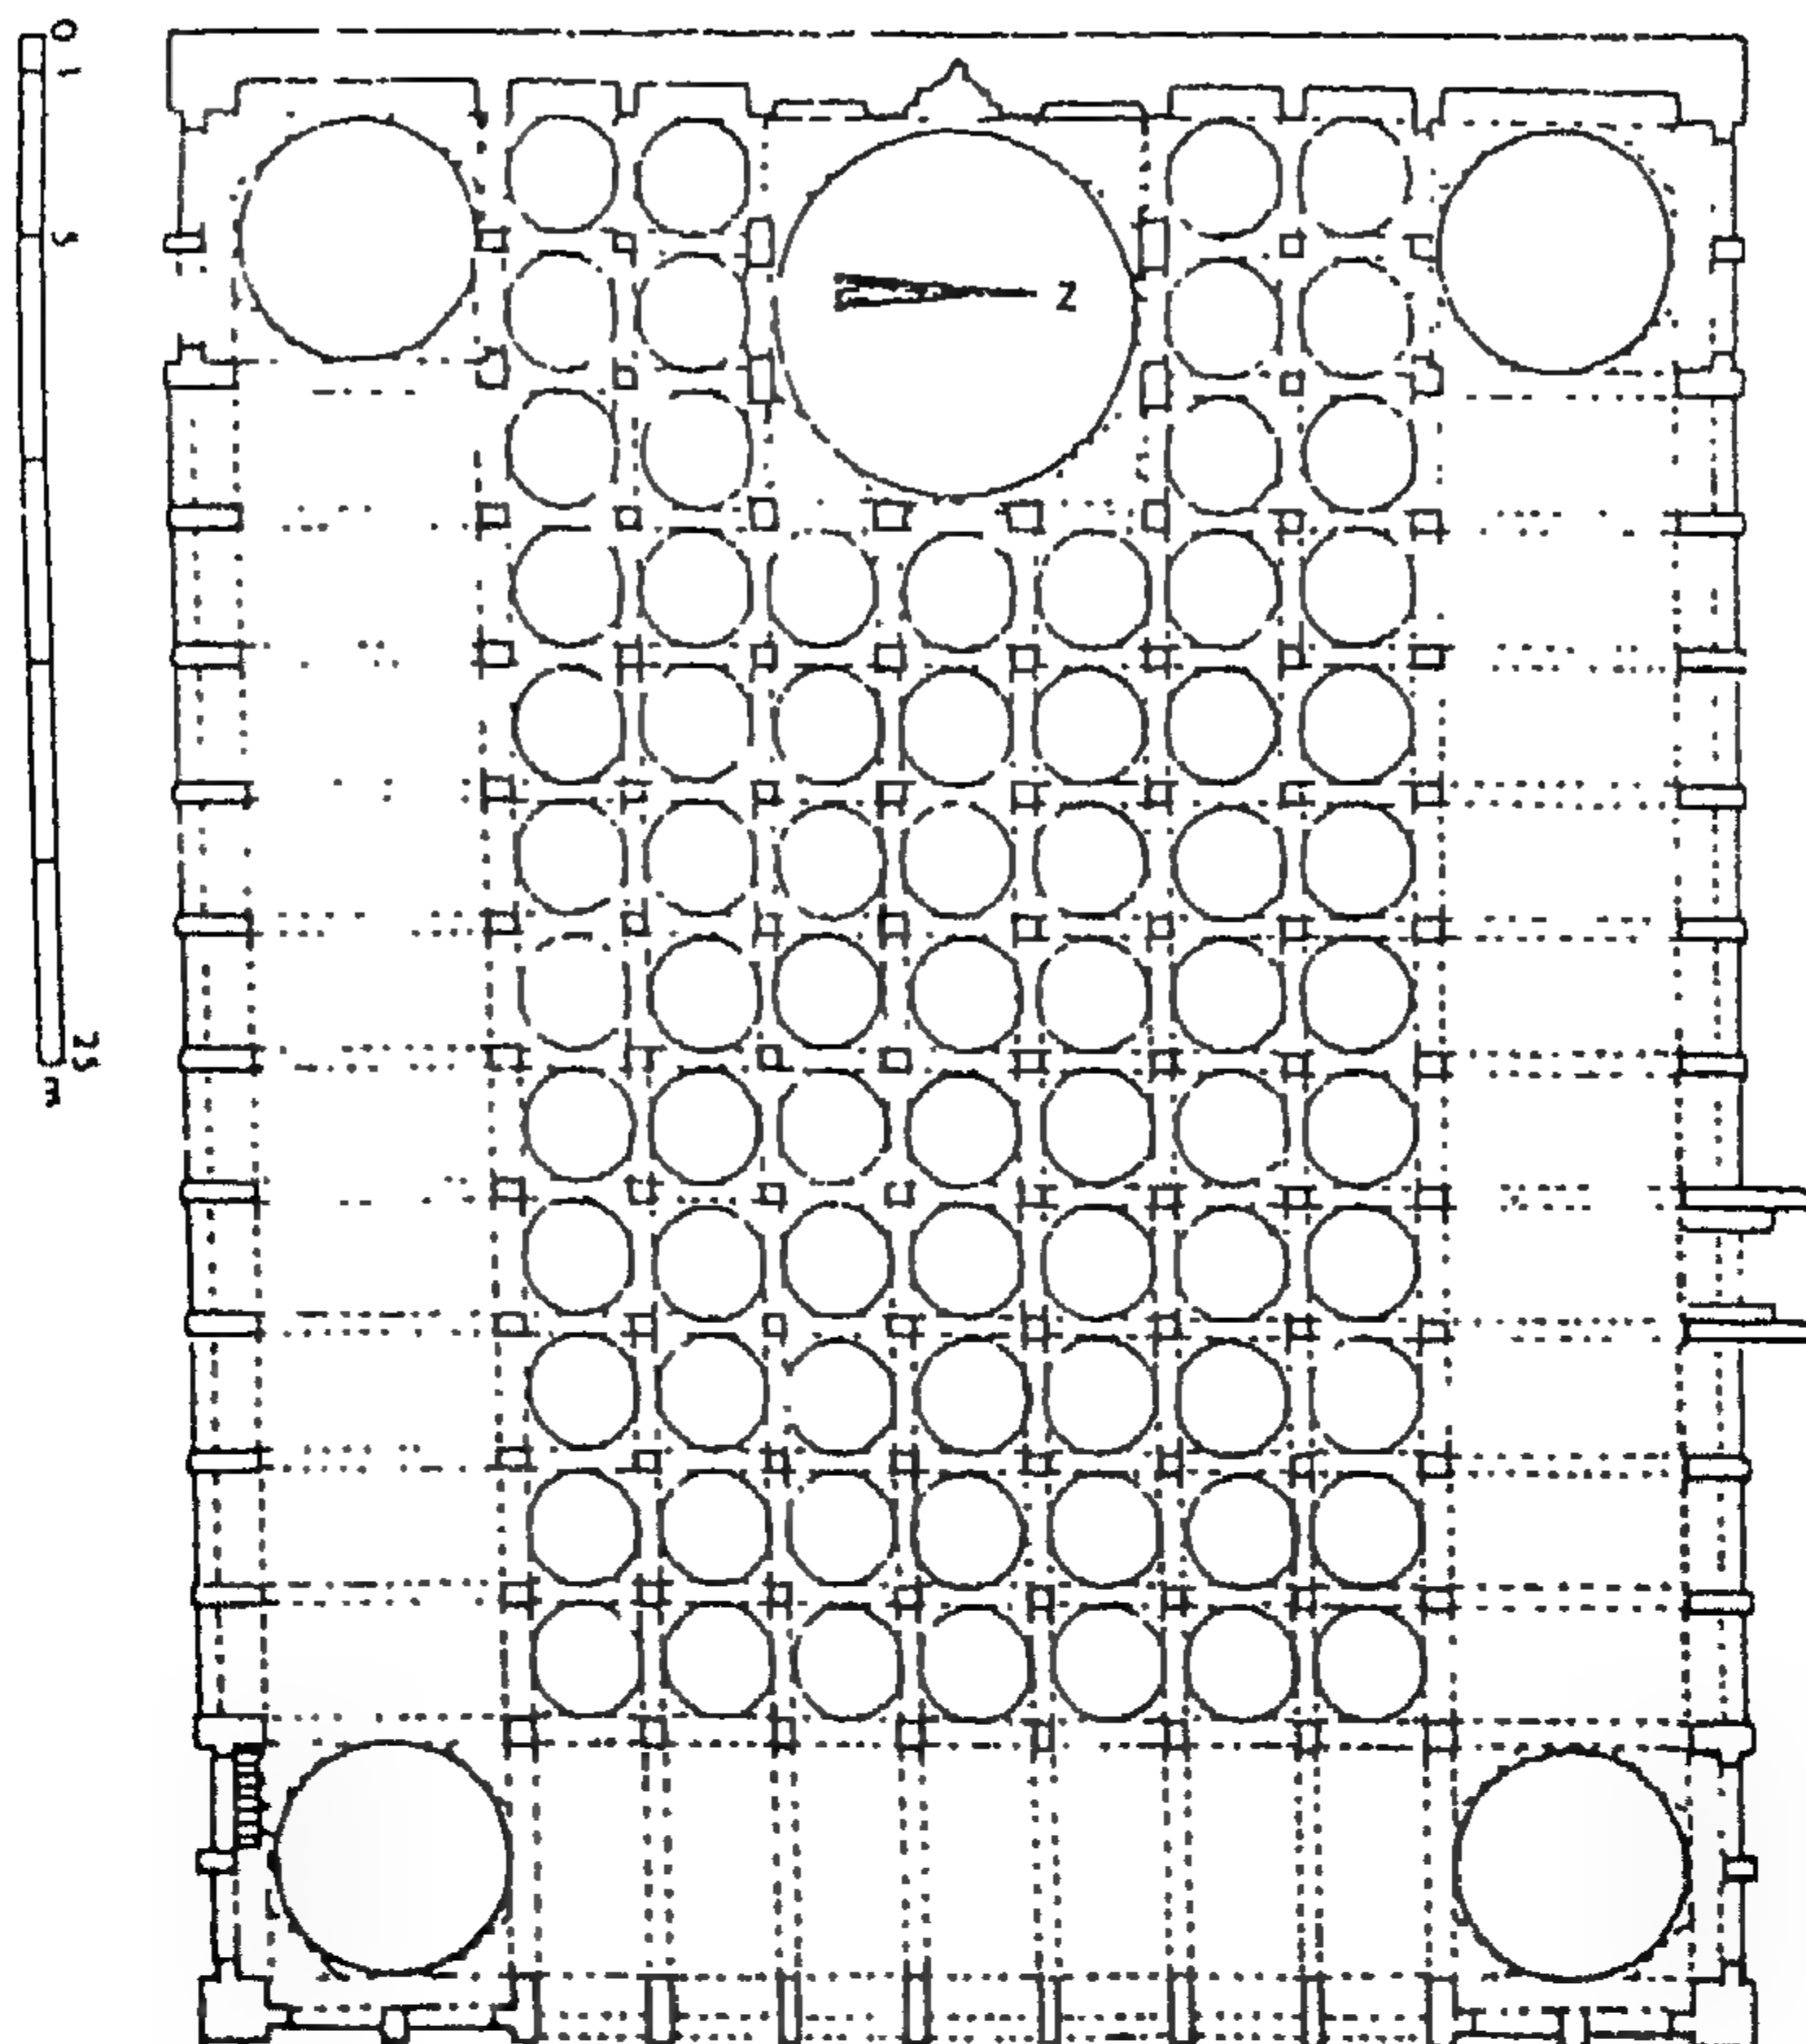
مسقط أفقي لمسجد علاء الدين في نيكده - (عن : أصلان آبا).
